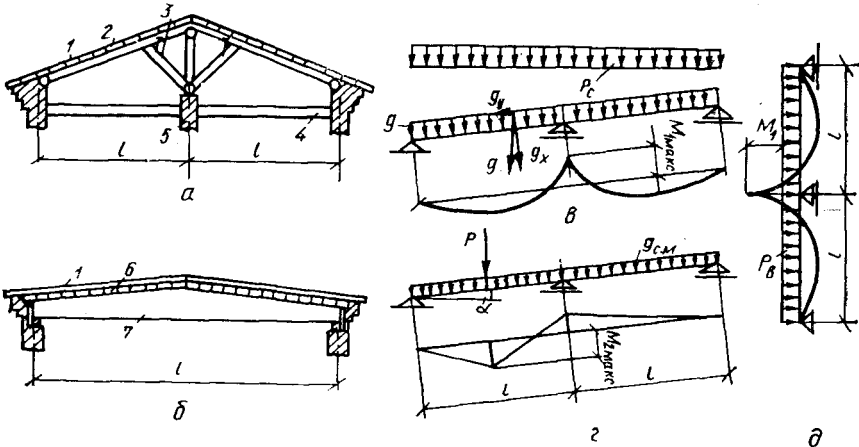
Виды покрытий и расчетные схемы настилов и обшивок стен:
